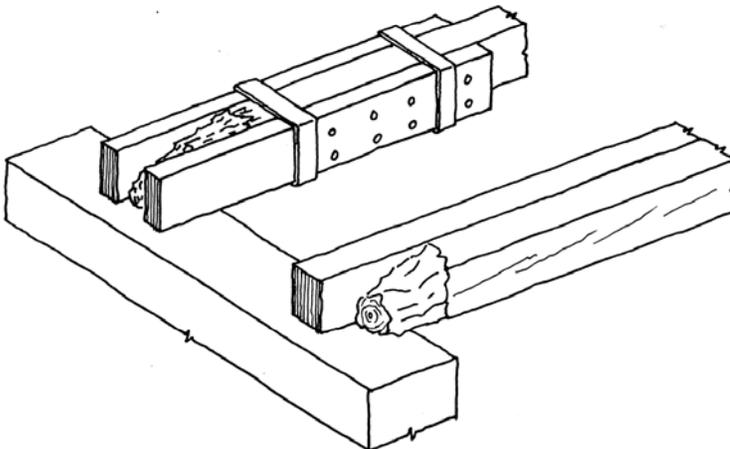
Refuerzo del apoyo de la viga mediante encepado con dos piezas o simple adosado de otra viga.
